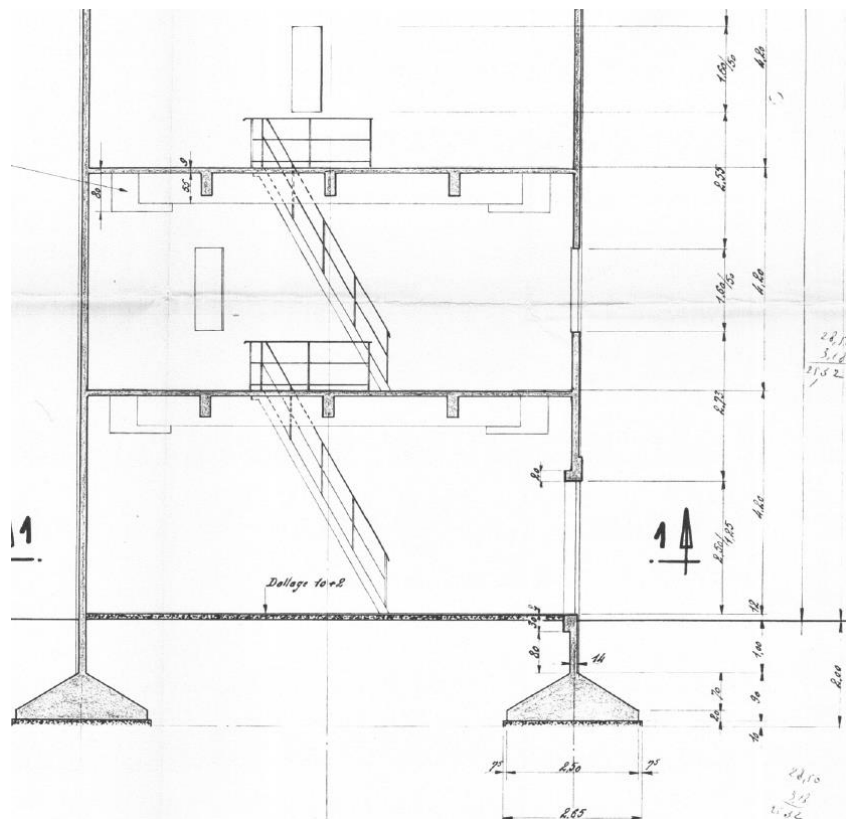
Géométrie fondations, dallage, dalles, et voiles
